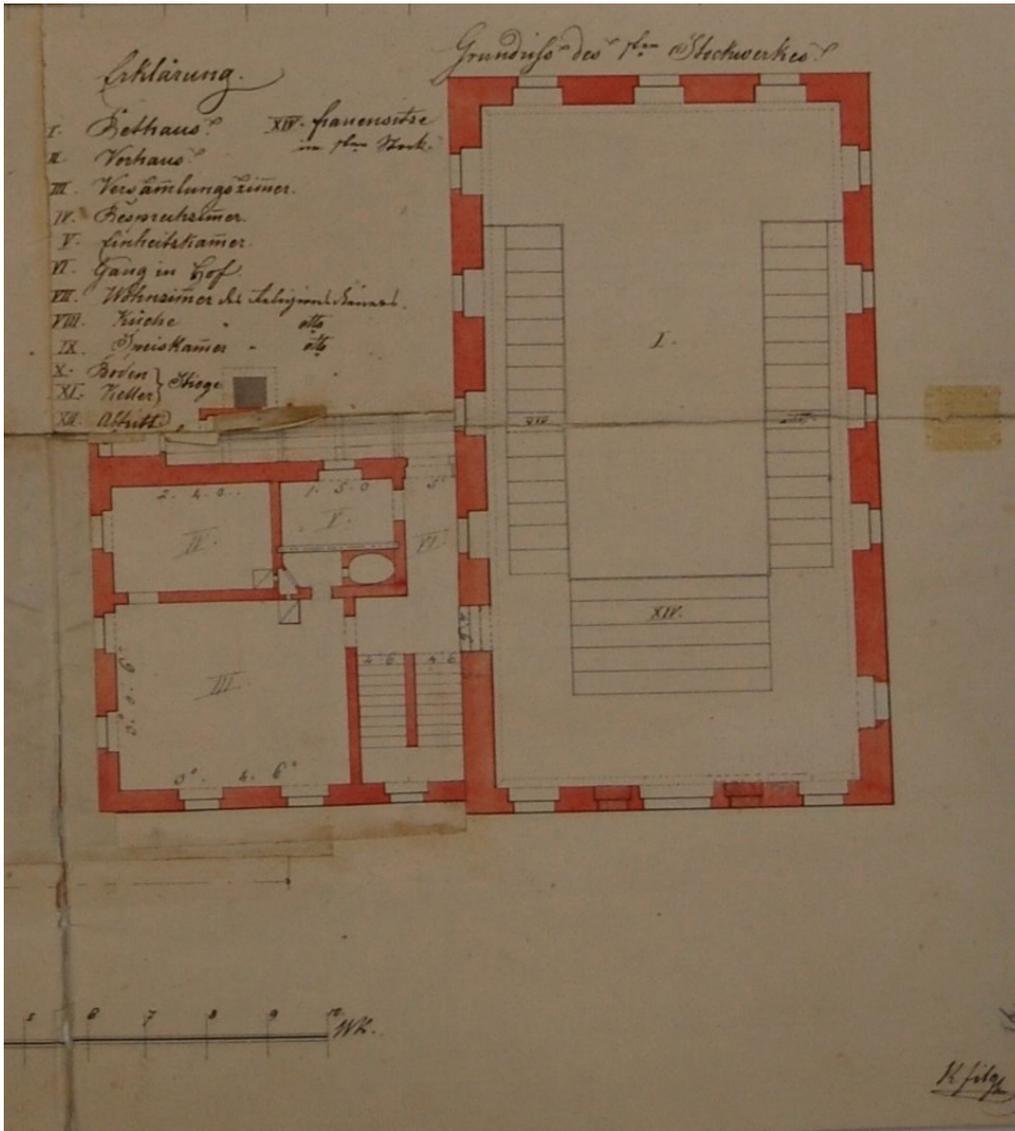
Grundriss 1. OG (ohne rechten Anbau)
